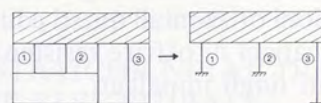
Schematizzazione a telaio a traverso rigido di un interpiano di parete.
